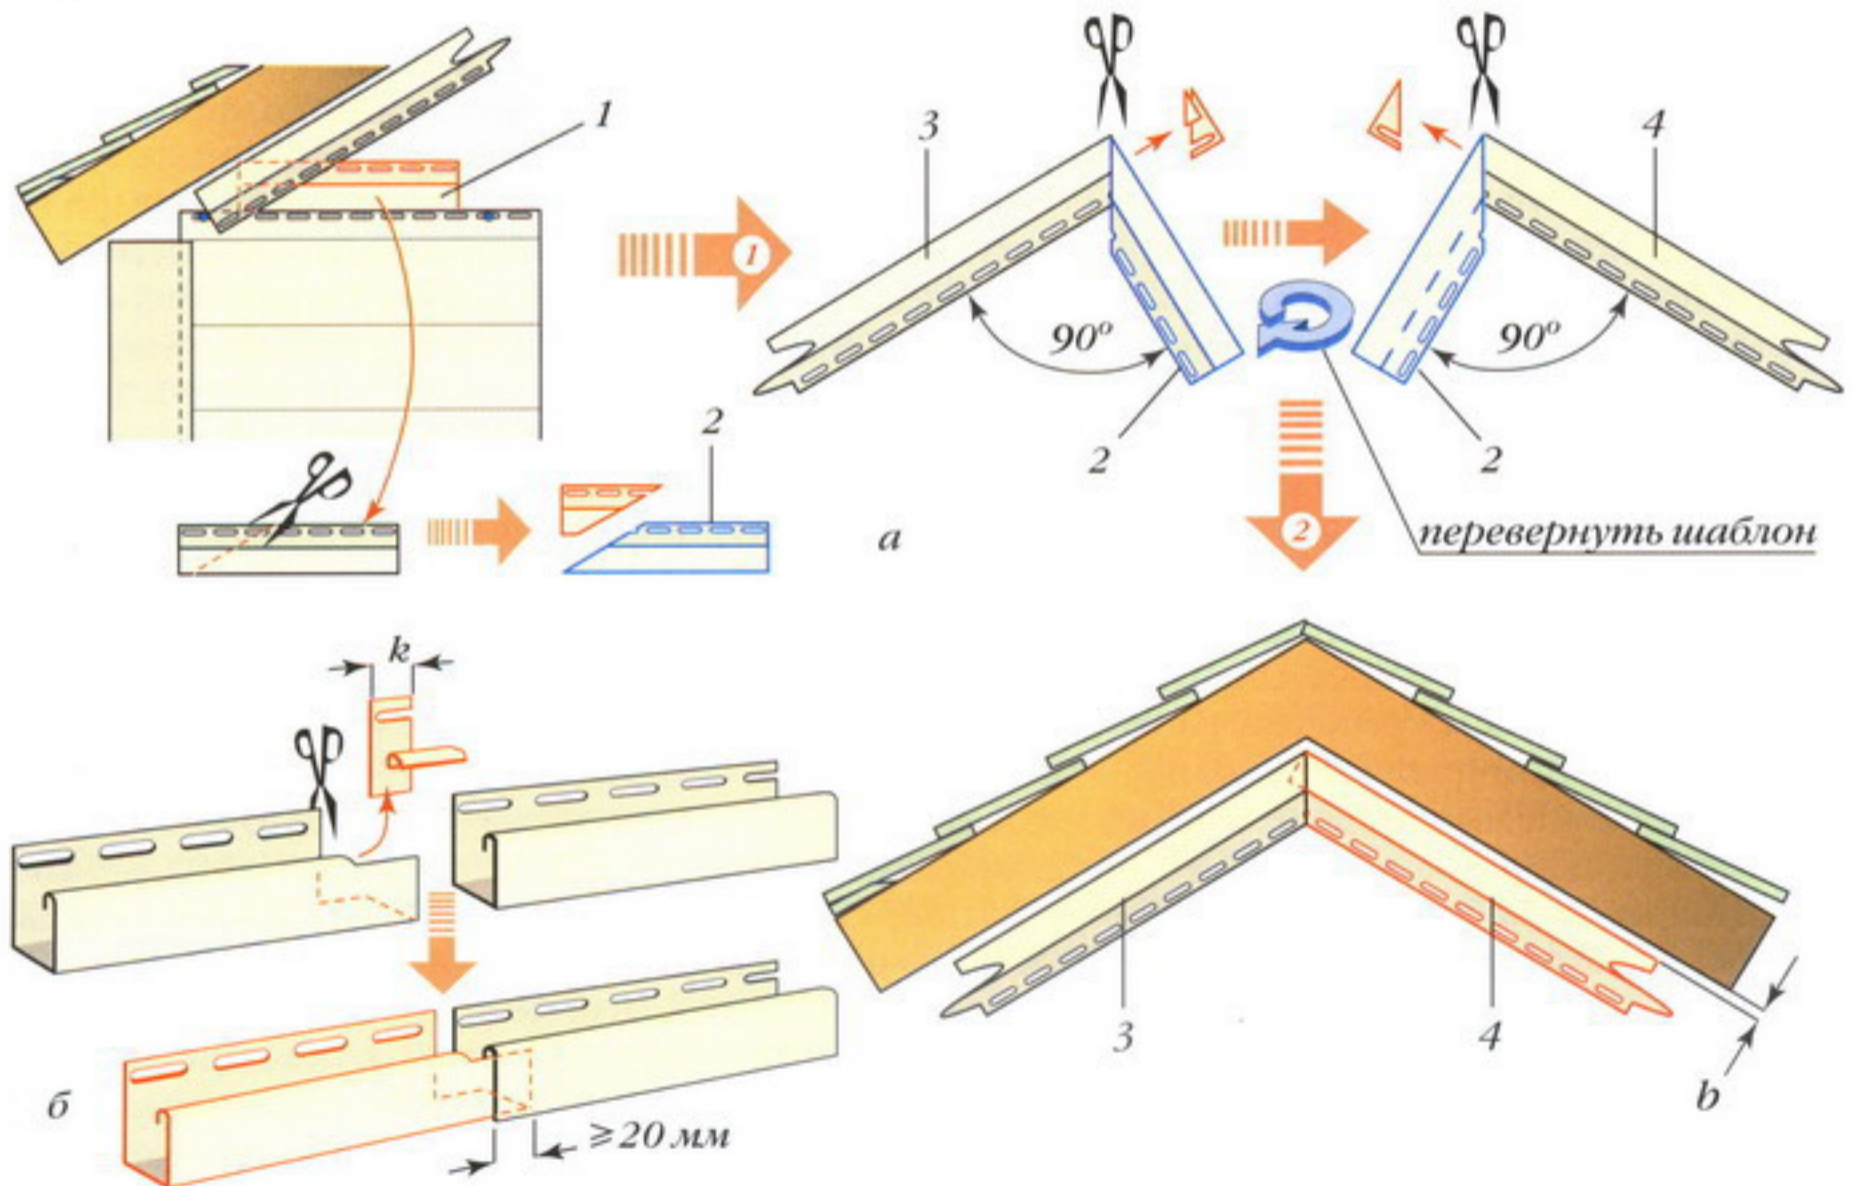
Установка J-профиля на щипец: а – вырезание шаблона и установка J-профиля; б – стыкование J-профиля по длине; 1 – обрезок J-профиля; 2 – шаблон; 3 – левый элемент обшивки; 4 – то же, правый; k – температурный зазор; b – отступ от свеса кровли
